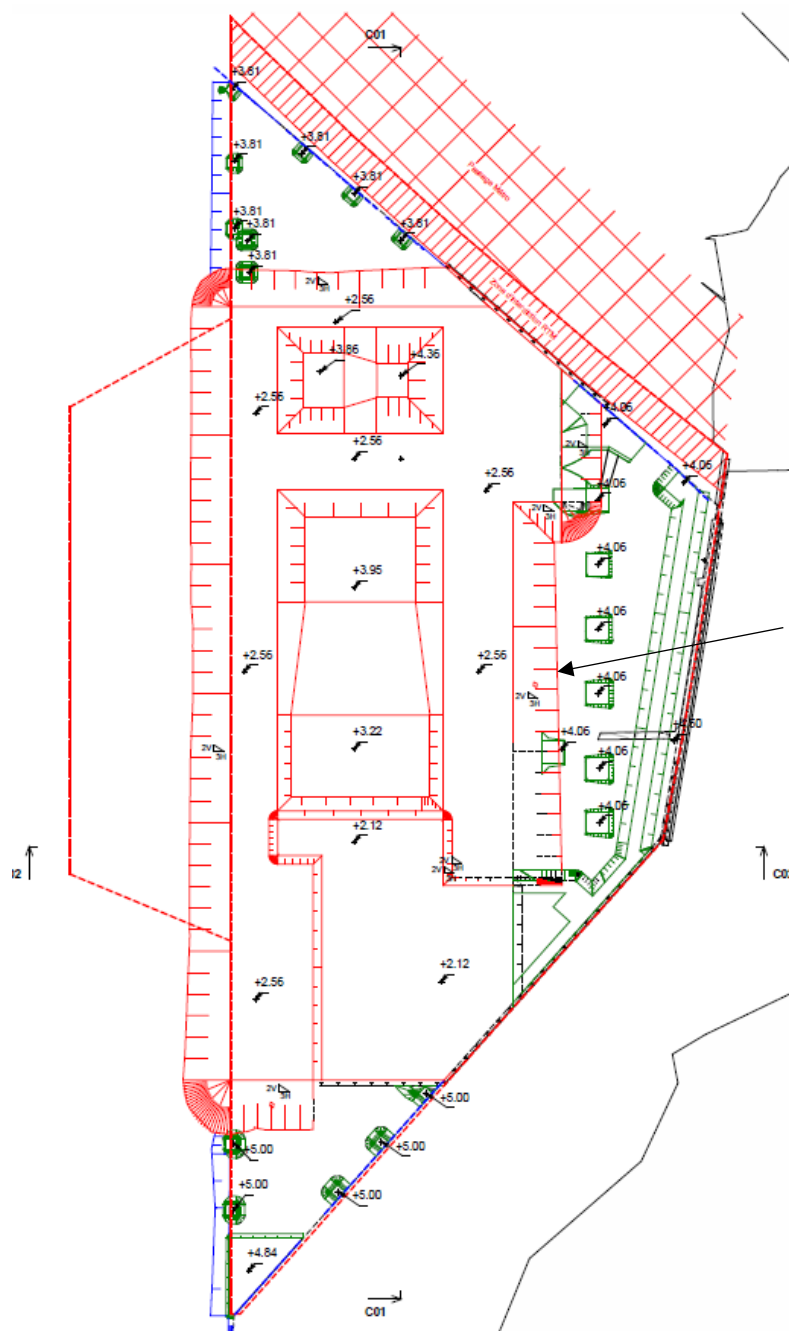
Extrait plan de terrassements 2107 PRO – Mai 2025
